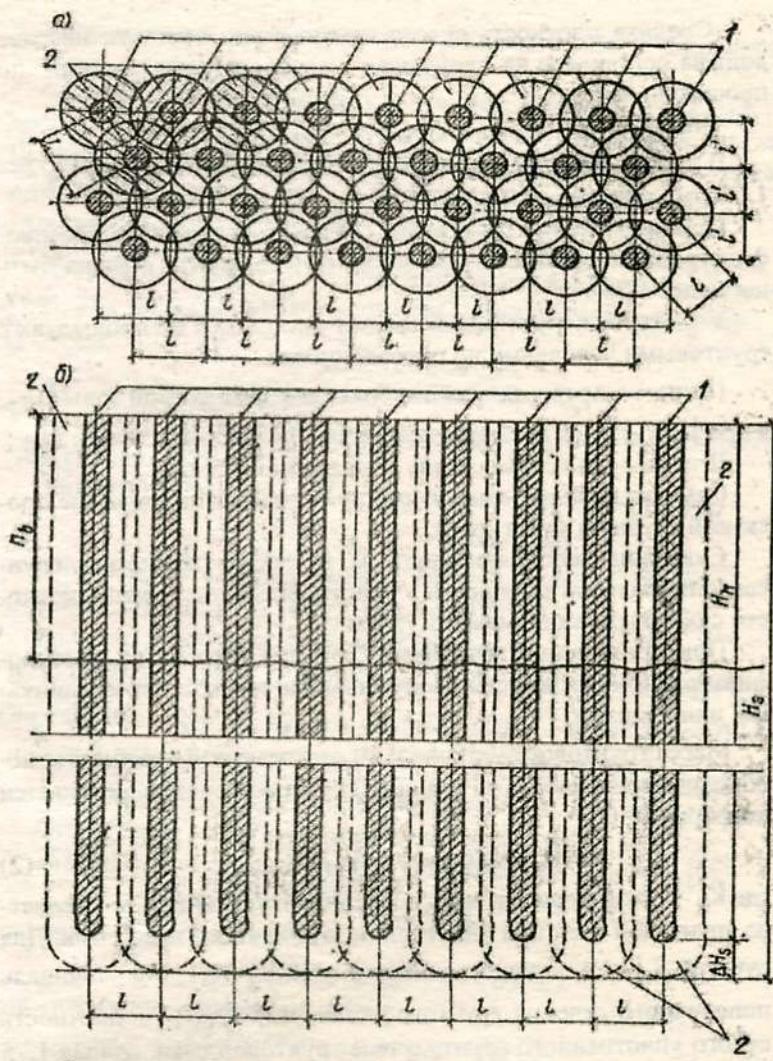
План расположения грунтовых свай (а) и поперечный разрез уплотненного массива (б)
